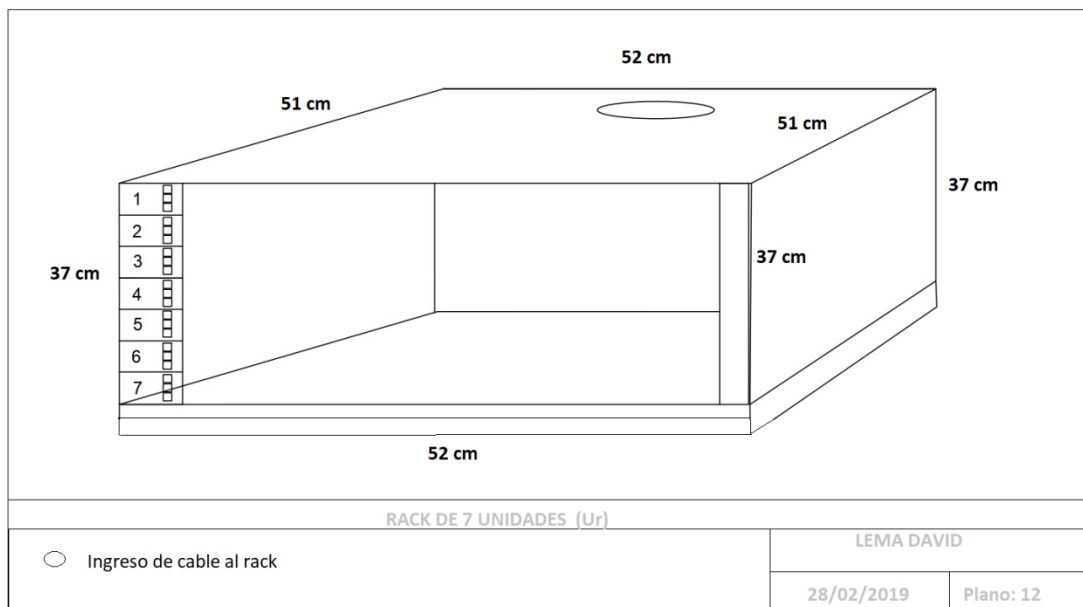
Ingreso de cables al *rack*, segunda planta.
